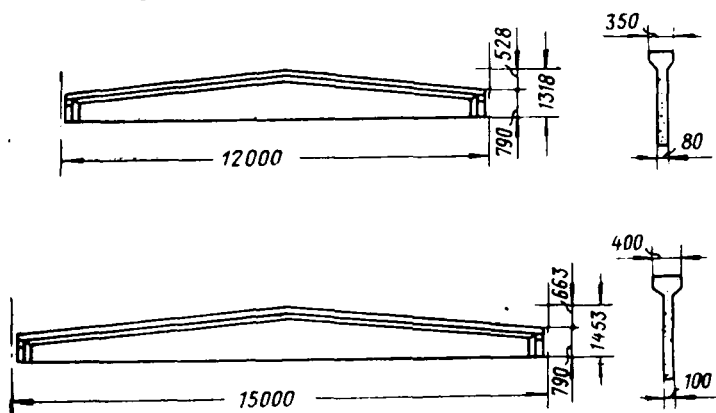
Двускатные тавровые балки пролетом 12 и 15 м серии ПК-01-05 с ненапрягаемой арматурой
